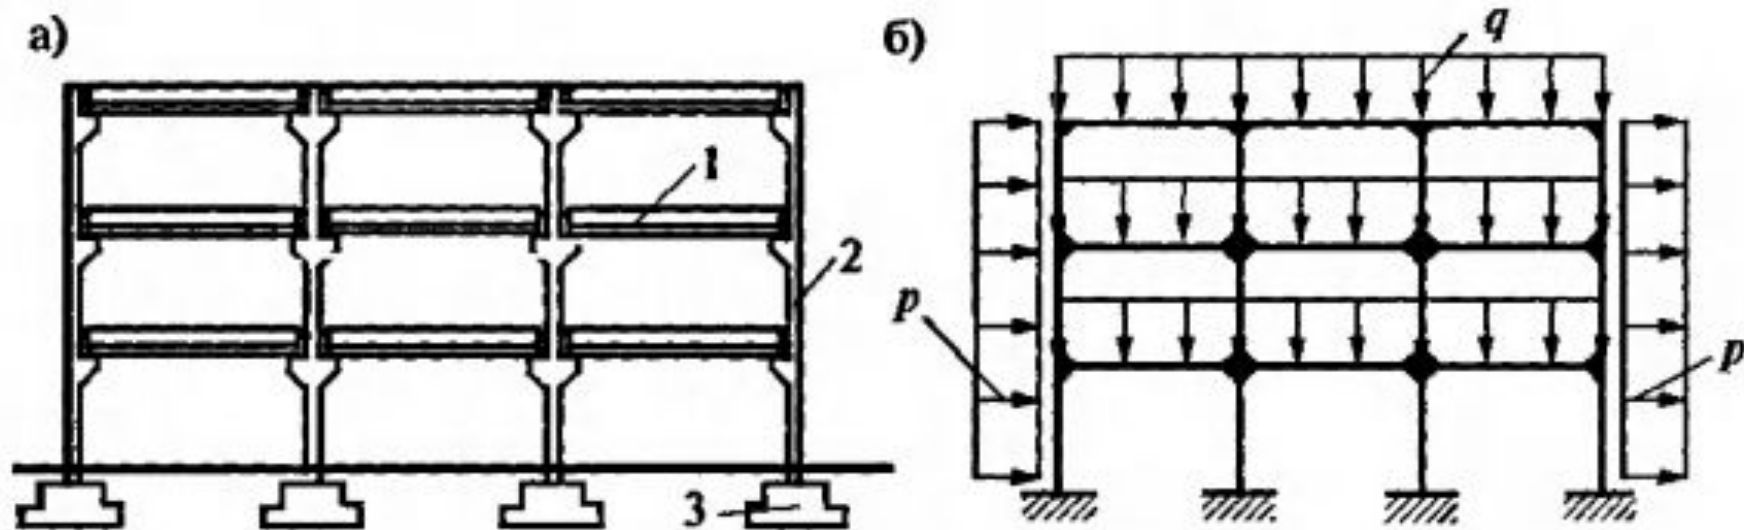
Рамная схема каркаса: а) конструктивная схема; б) расчетная схема; 1 — неразрезанный ригель; 2 — колонна; 3 — фундамент
